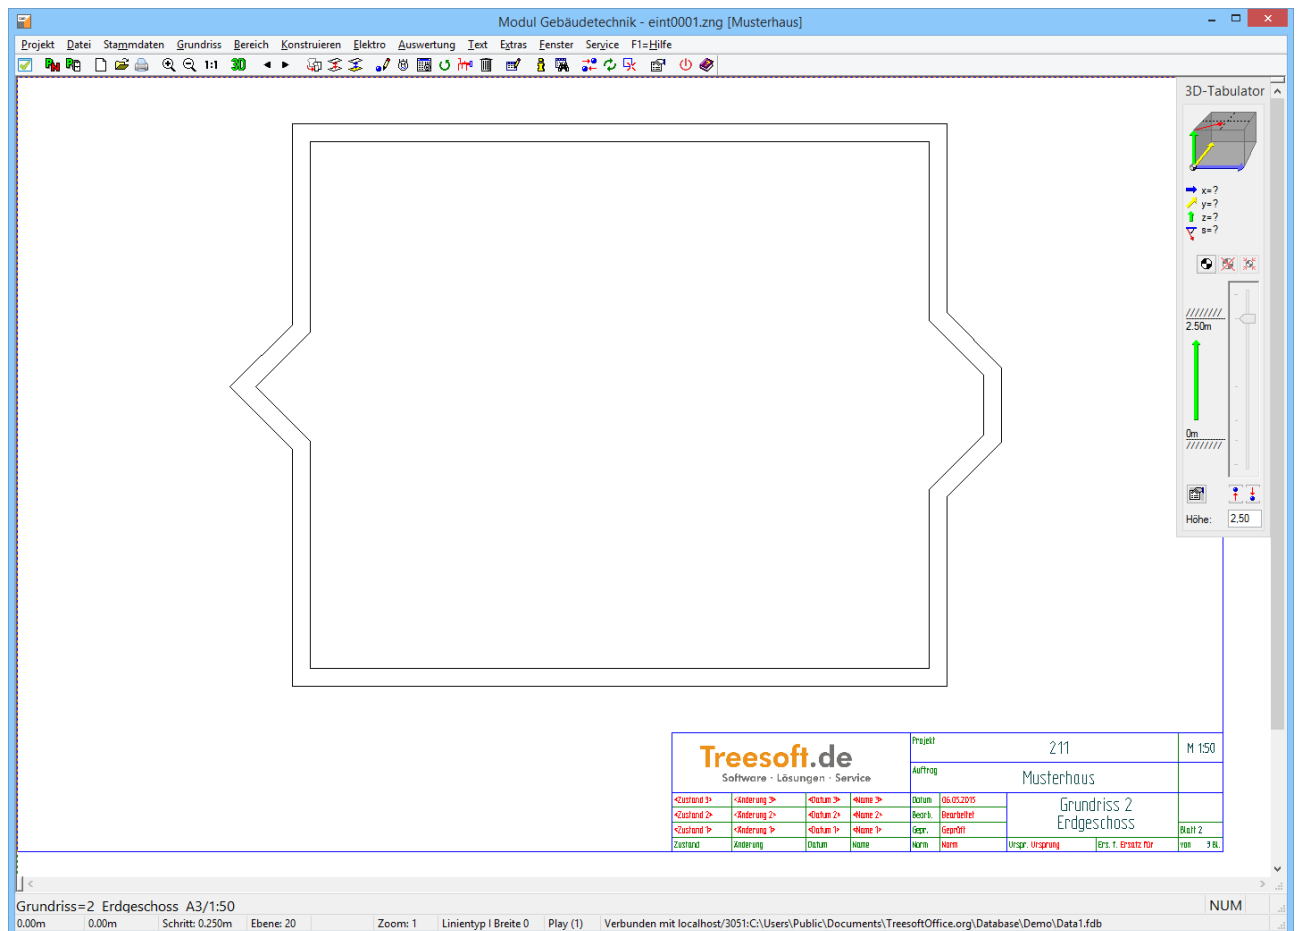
Vermittelter Grundriss
